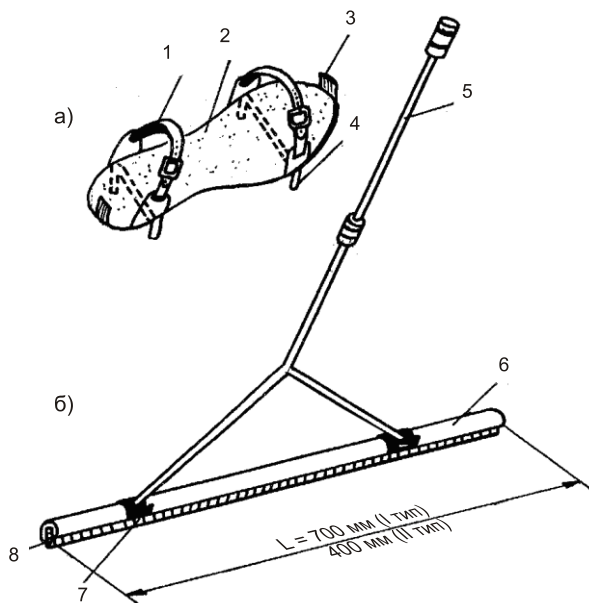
Приспособления, используемые рабочими, занятыми на изготовлении самонивелирующихся стяжек: а — подножка; б — гладилка;
